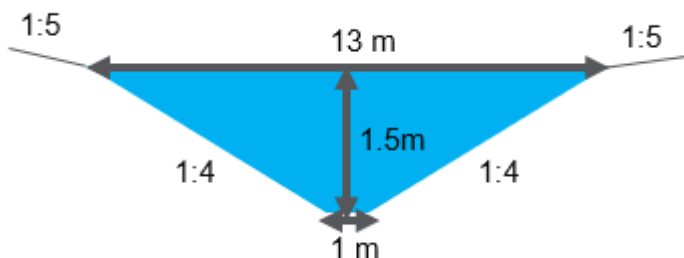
Schematische weergave stedelijk water (geen beschoeiing).
